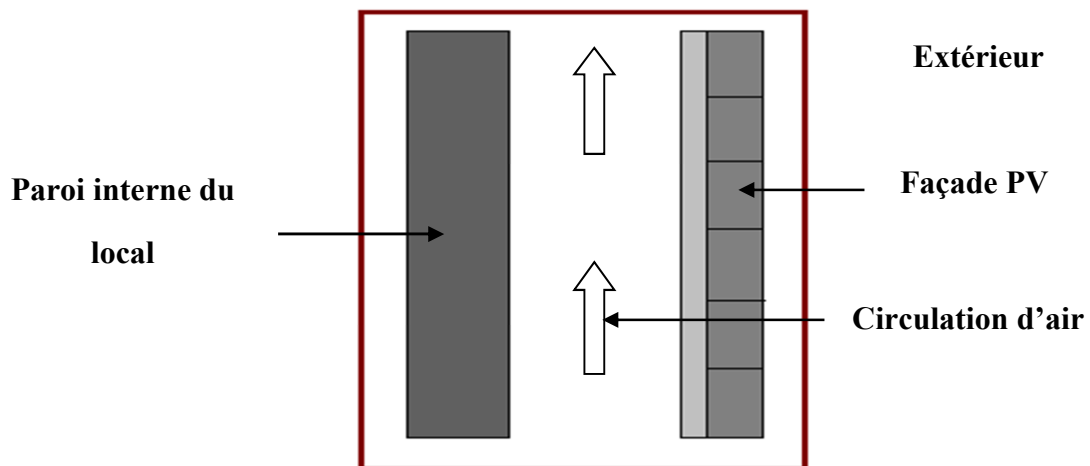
Coupe de la lame d'air en sous-face des panneaux PV
